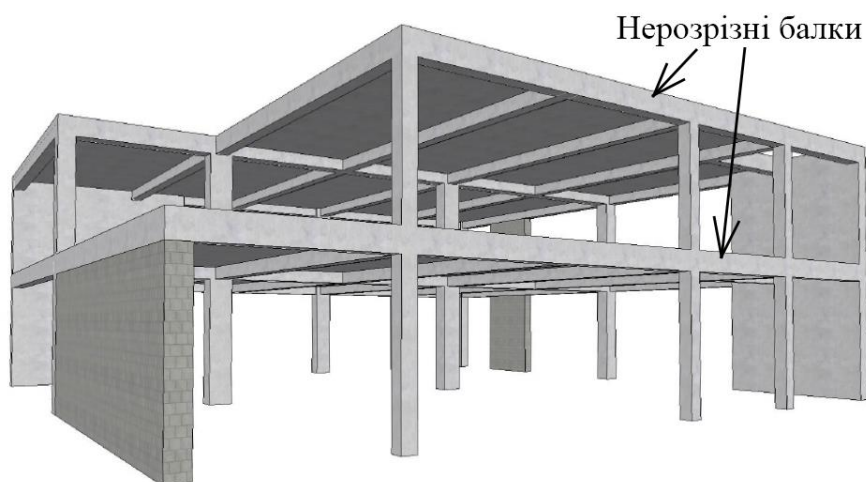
Нерозрізні балки у складі конструкцій монолітного перекриття будівель
